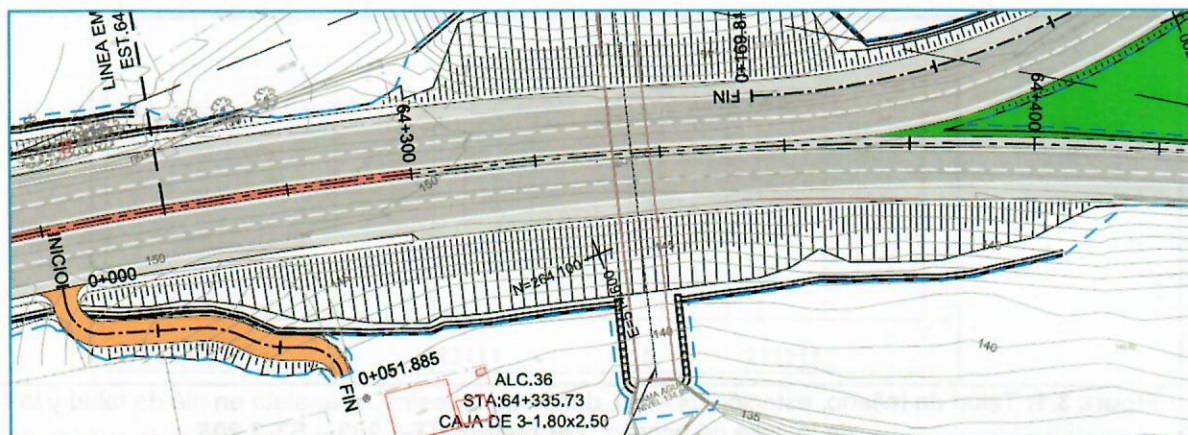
Tramo: 64+240-64+420, LD. Ver planos de planta perfil: PP-42 y PP-43.
